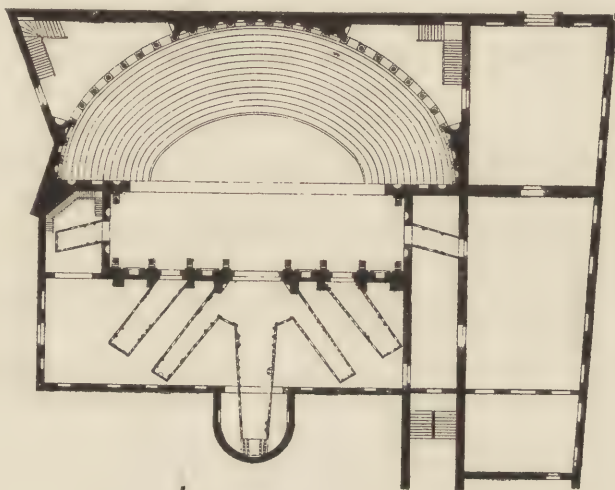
Teatro Olimpico zu Vicenza, Grundriss.
